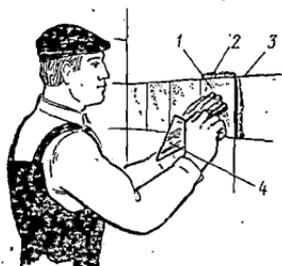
Облицовка стены стеклянной плиткой: 1 — укладываемая плитка, 2 — излишки выдавленного раствора, 3 — причальный шнур, 4 — лопатка
